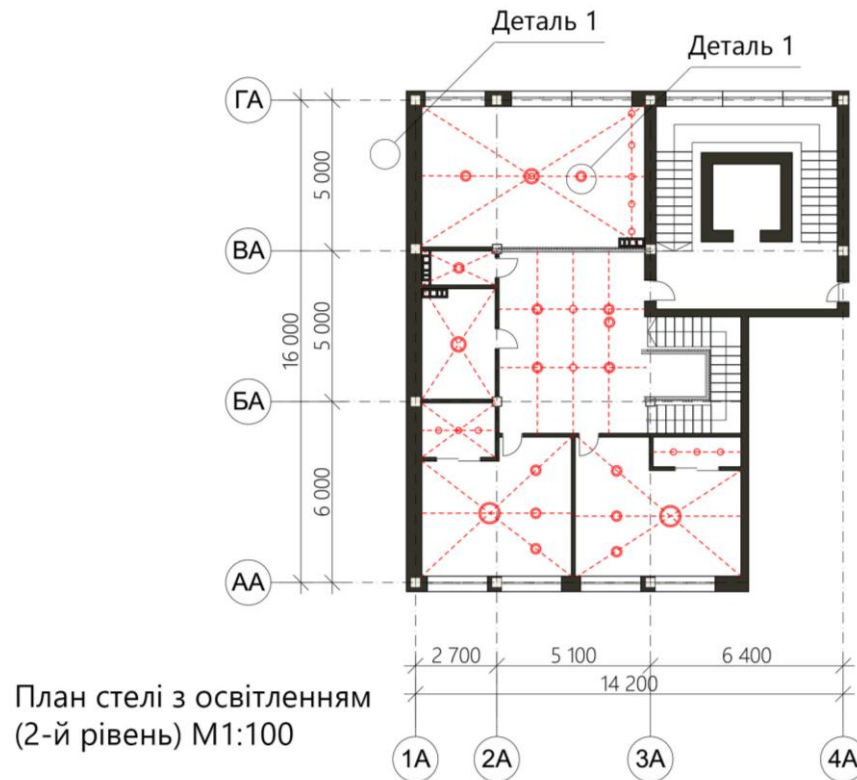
План стелі 2-го рівню з освітленням.
